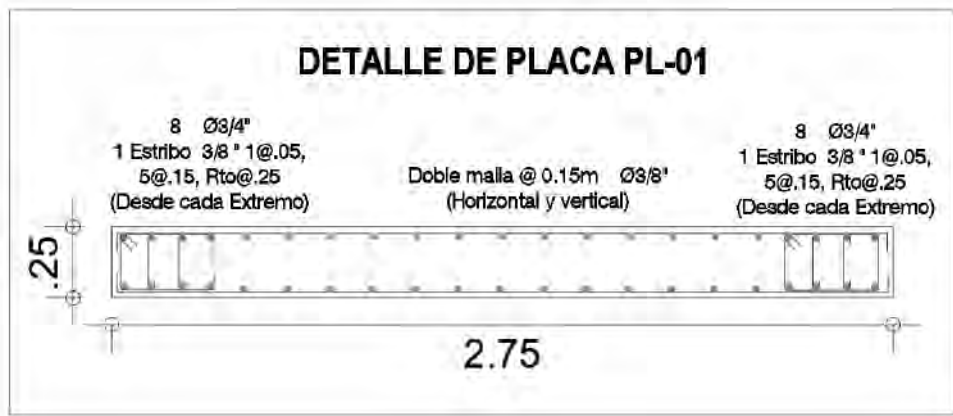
Detalle final de la placa PL-01, segunda propuesta de reforzamiento
